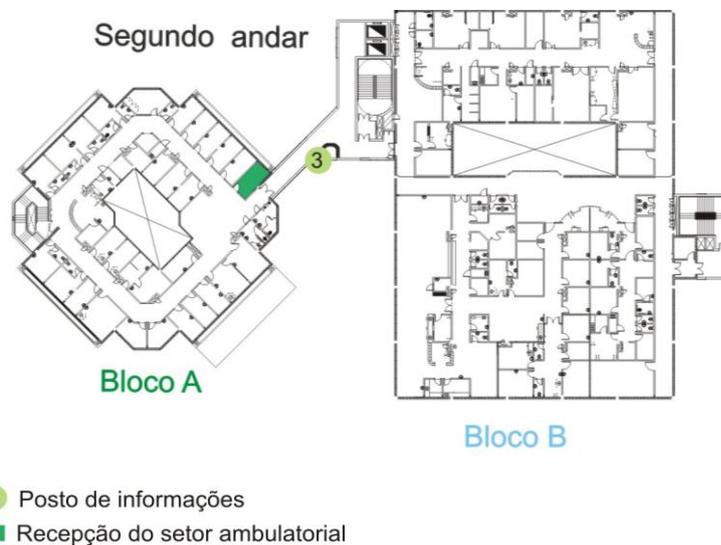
Planta baixa com a indicação da localização da recepção do segundo andar
